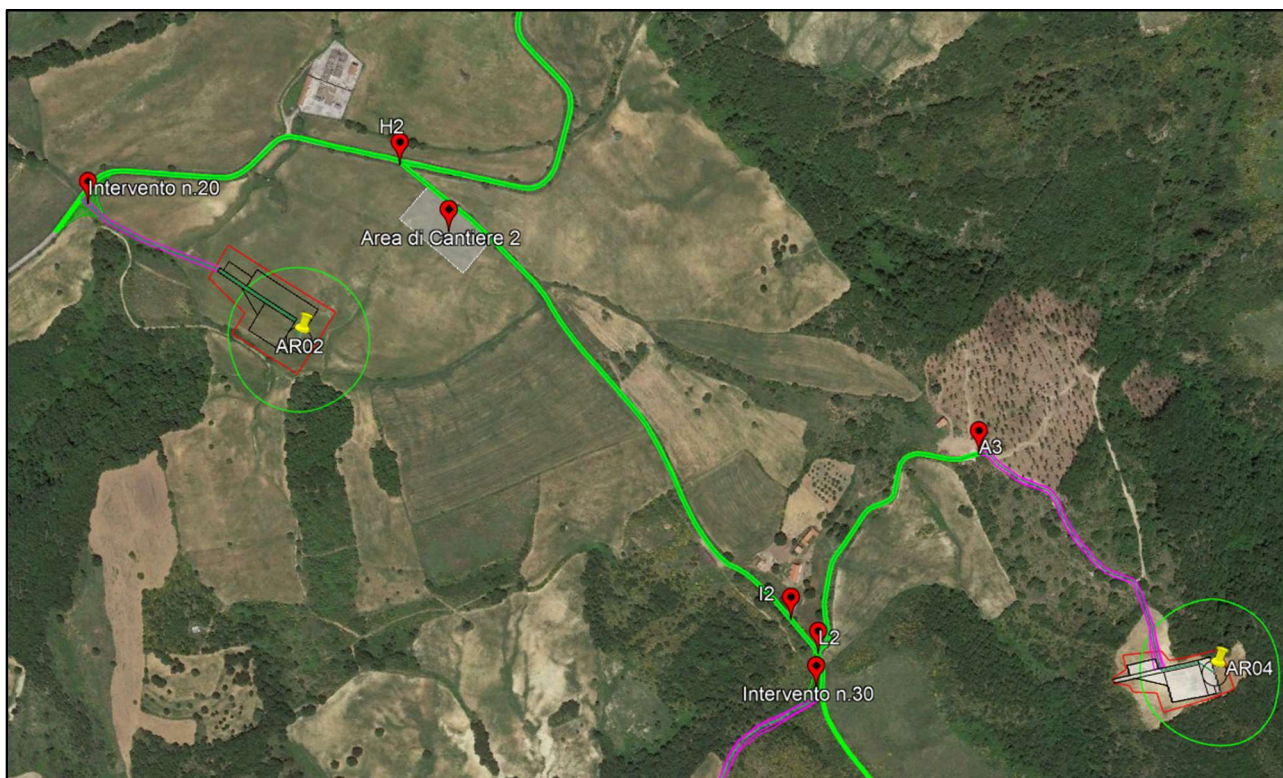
Localizzazione Area di Cantiere 2 – Itinerario n.2 (Verde)
